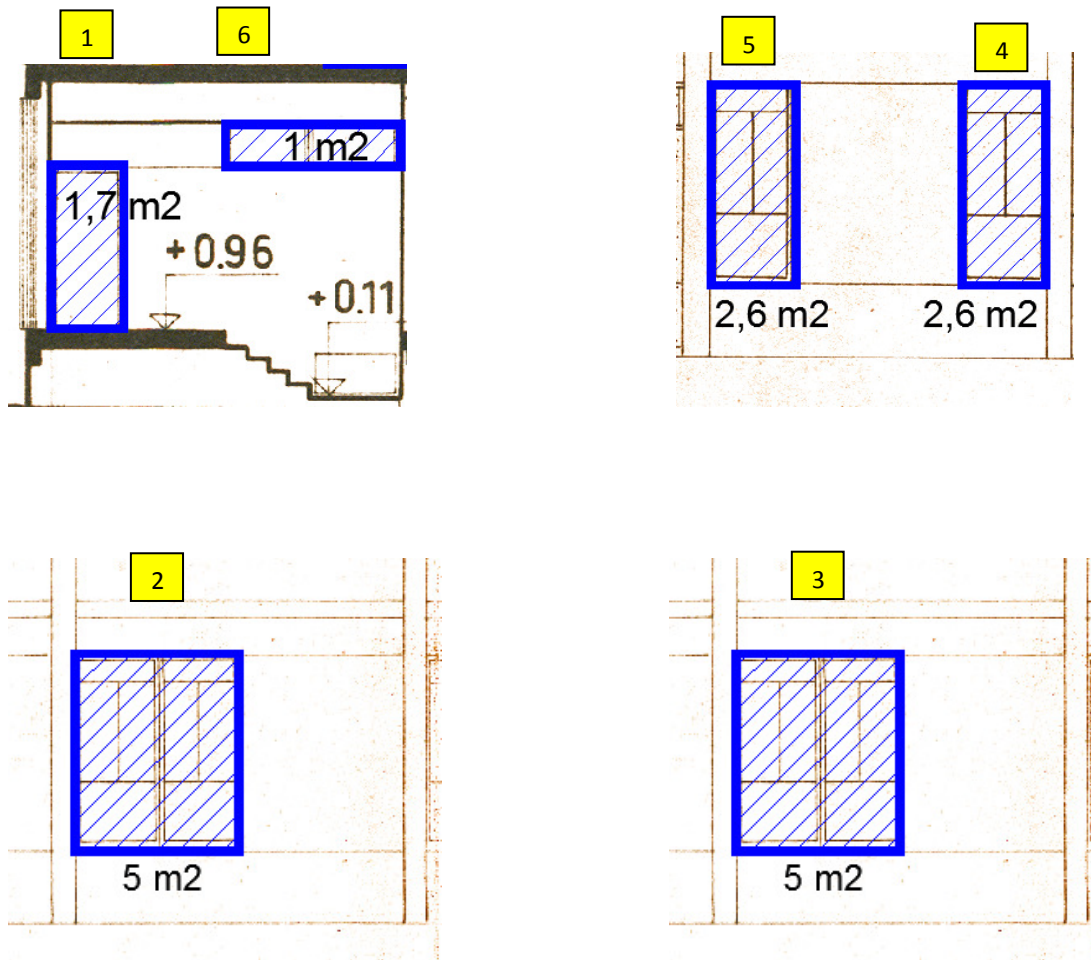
Superficies de las aperturas vivienda tipo F.
